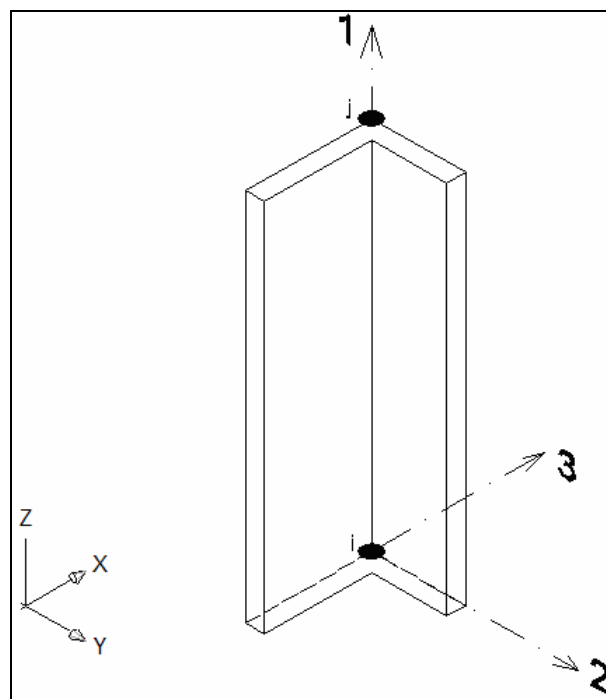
Ejes locales para un elemento (FRAME) vertical
